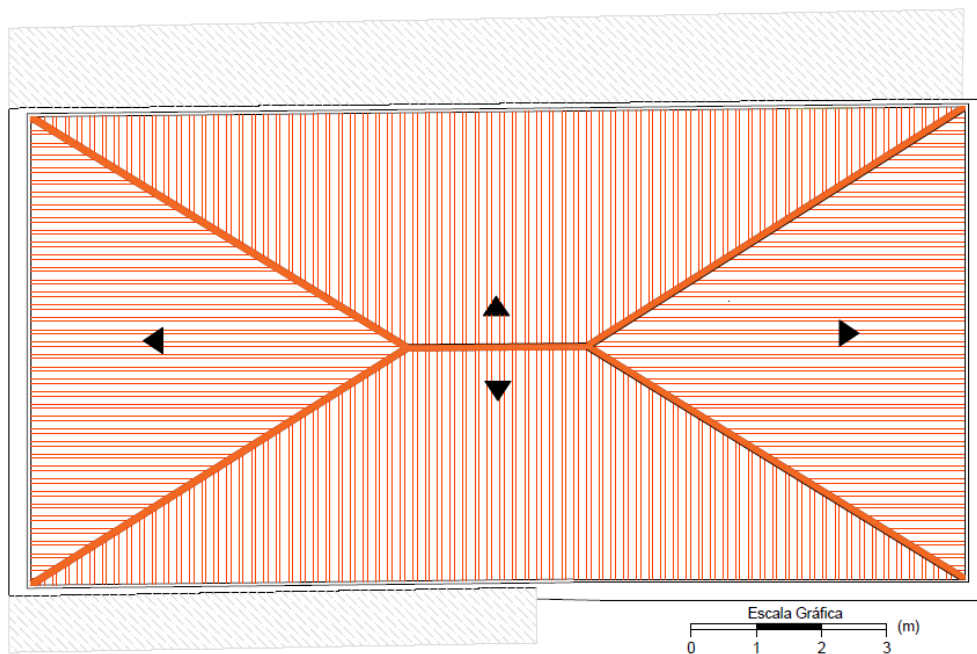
Planta da Cobertura do Edifício Reabilitado
